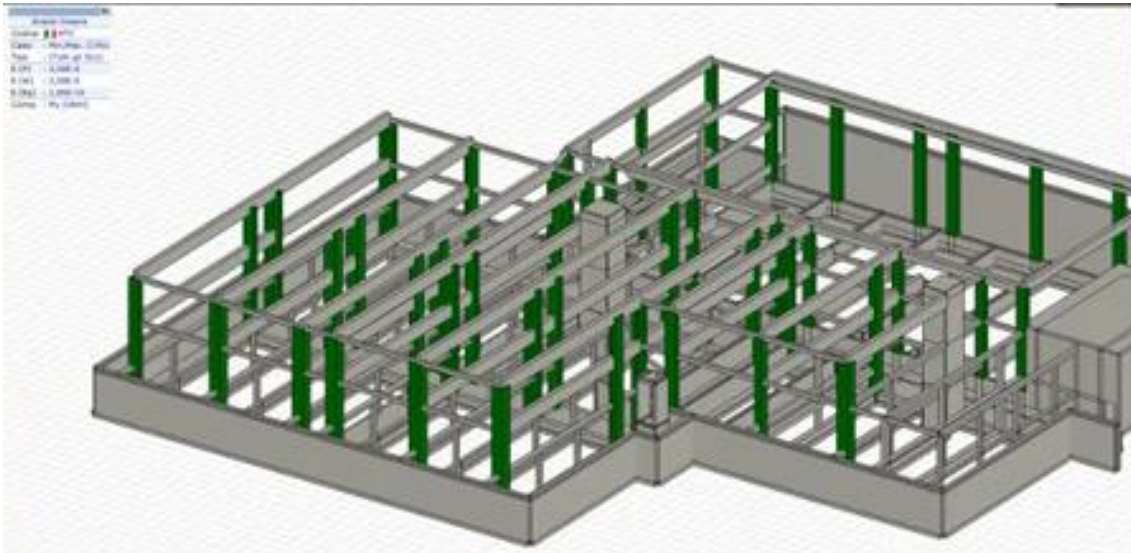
AxisVM – Visualizzazione 3D del modello dello stato di progetto con i pilastri dell’orditura principale interessati dall’intervento di ampliamento della sezione
